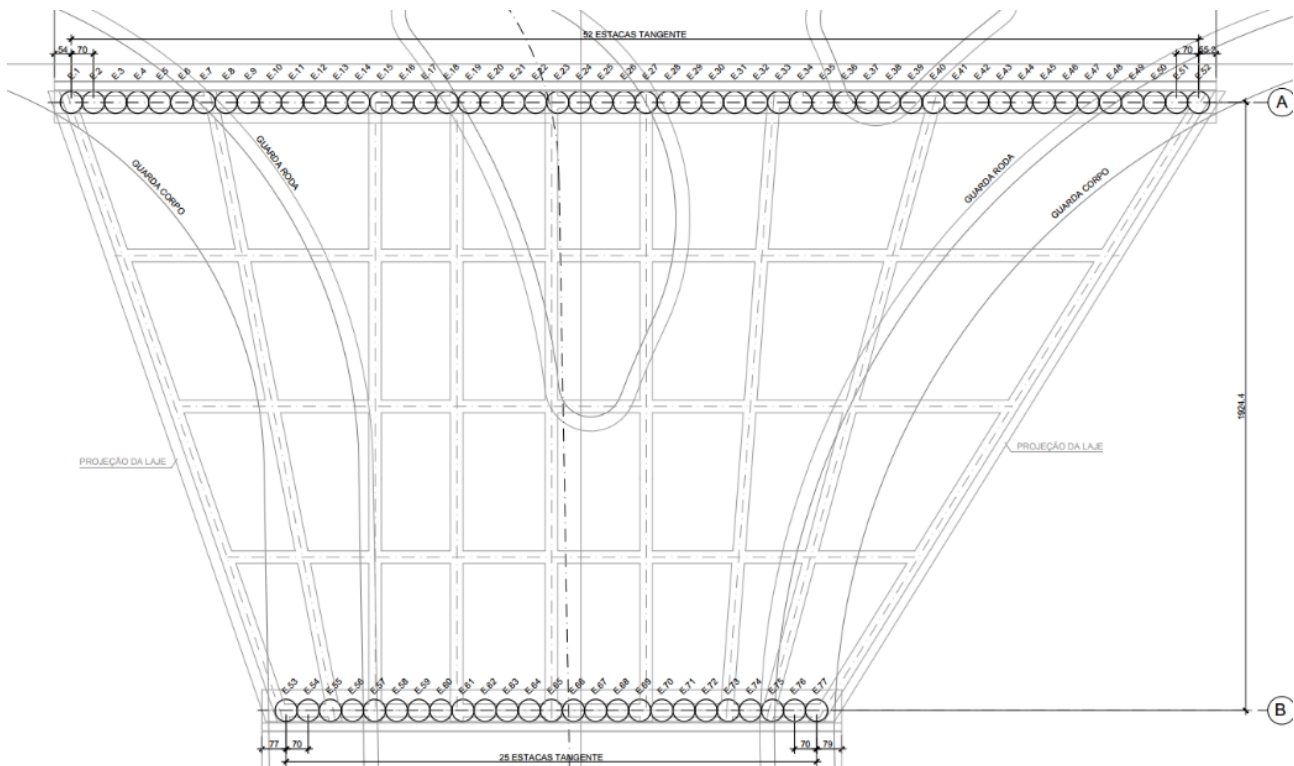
PLANTA - LOCAÇÃO DAS ESTACAS
